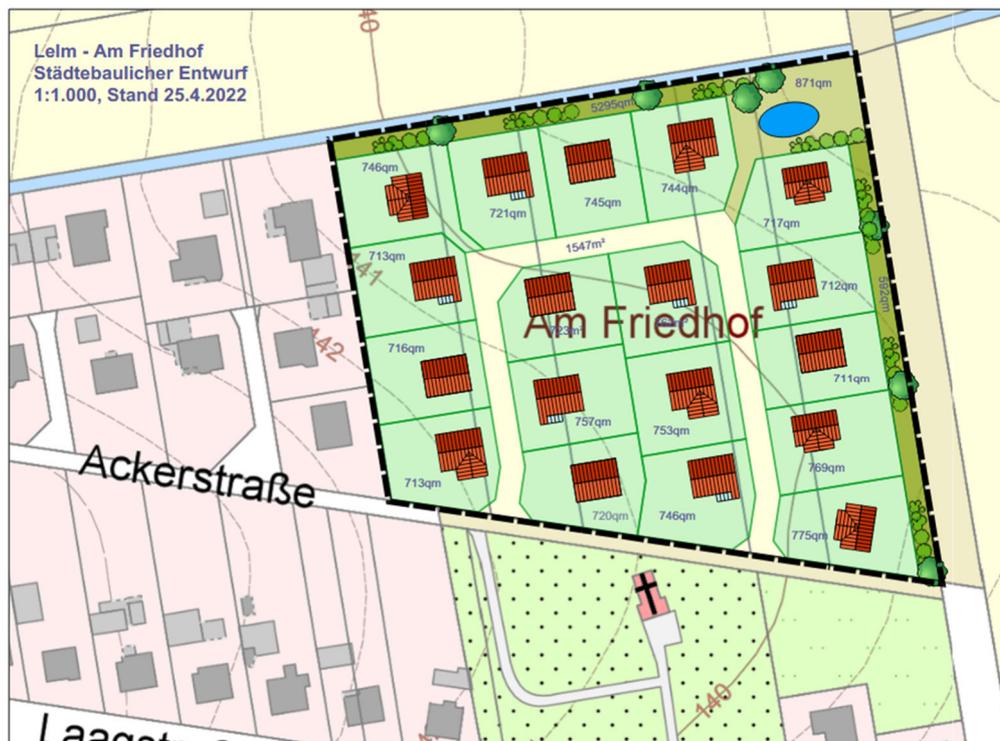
Städtebaulicher Entwurf (Arch. Voigts)
